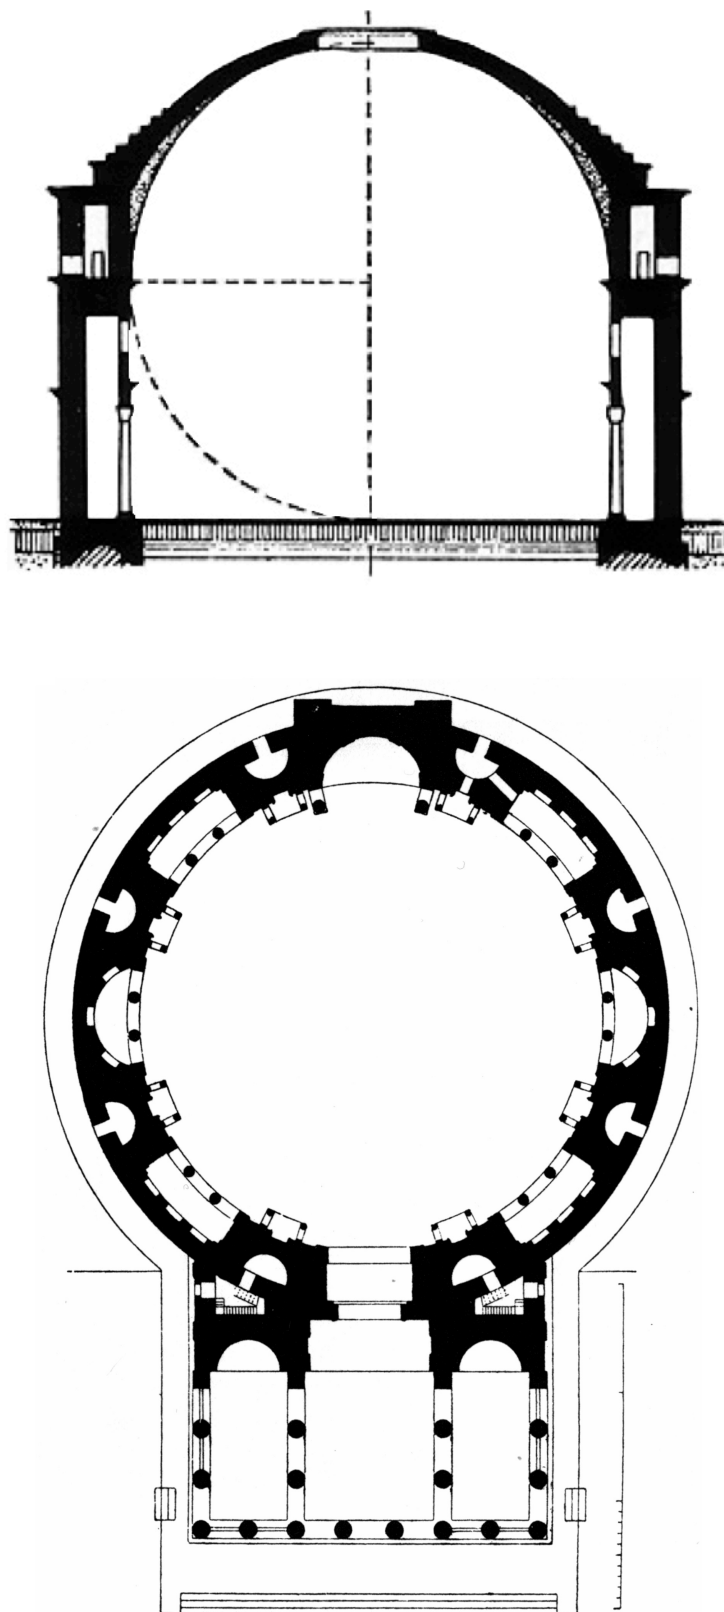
Planta e Secção Transversal do Panteão de Roma.
